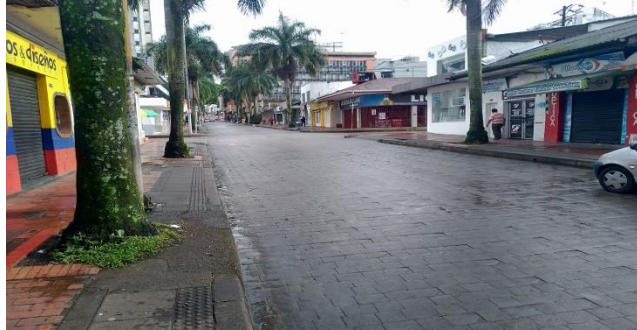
Tramo vial Calle 35- Calle 37. Concreto estampado
